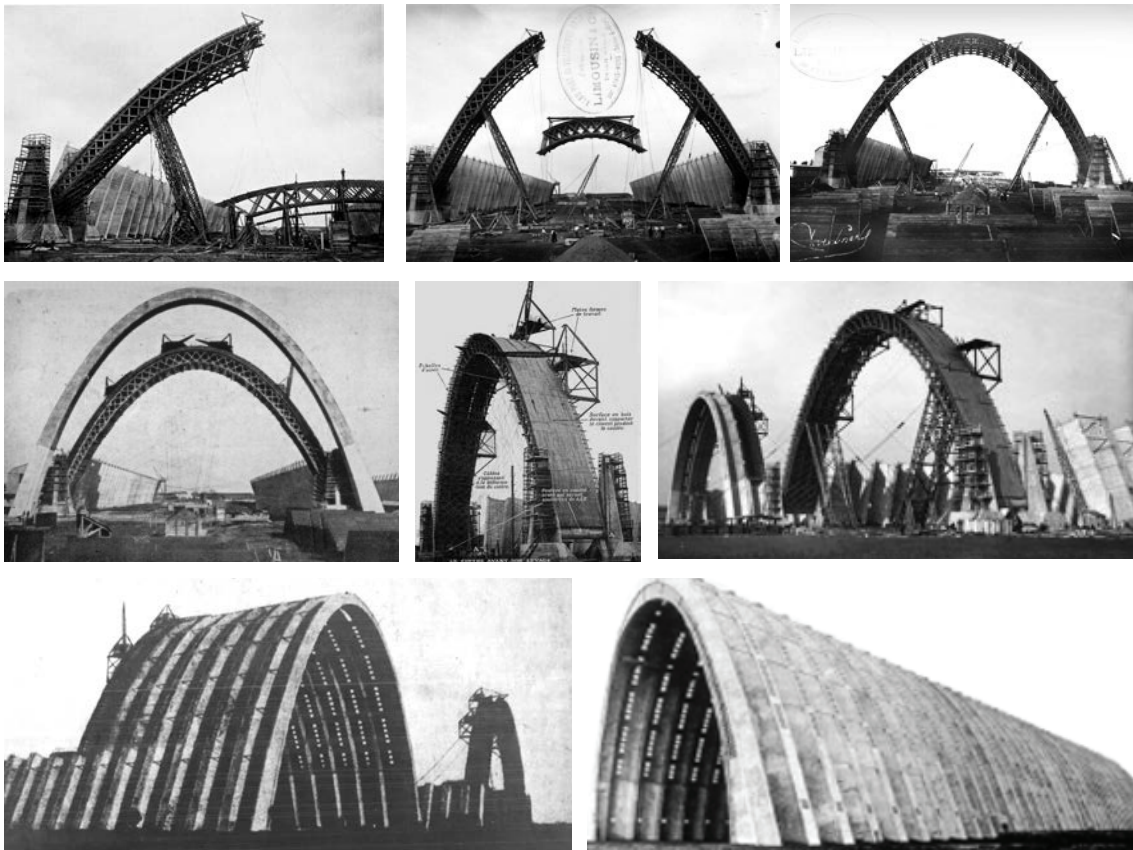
Secuencia de construcción del proyecto de nervaduras estructurales, tomadas entre Abril y Setiembre de 1923.
